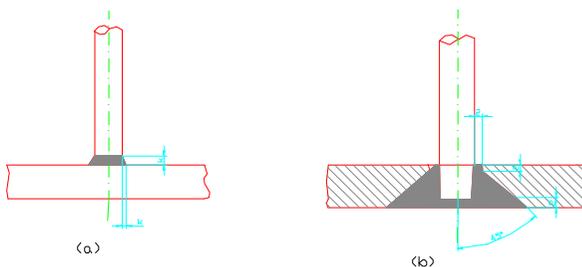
预埋件钢筋电弧焊 T 型接头
